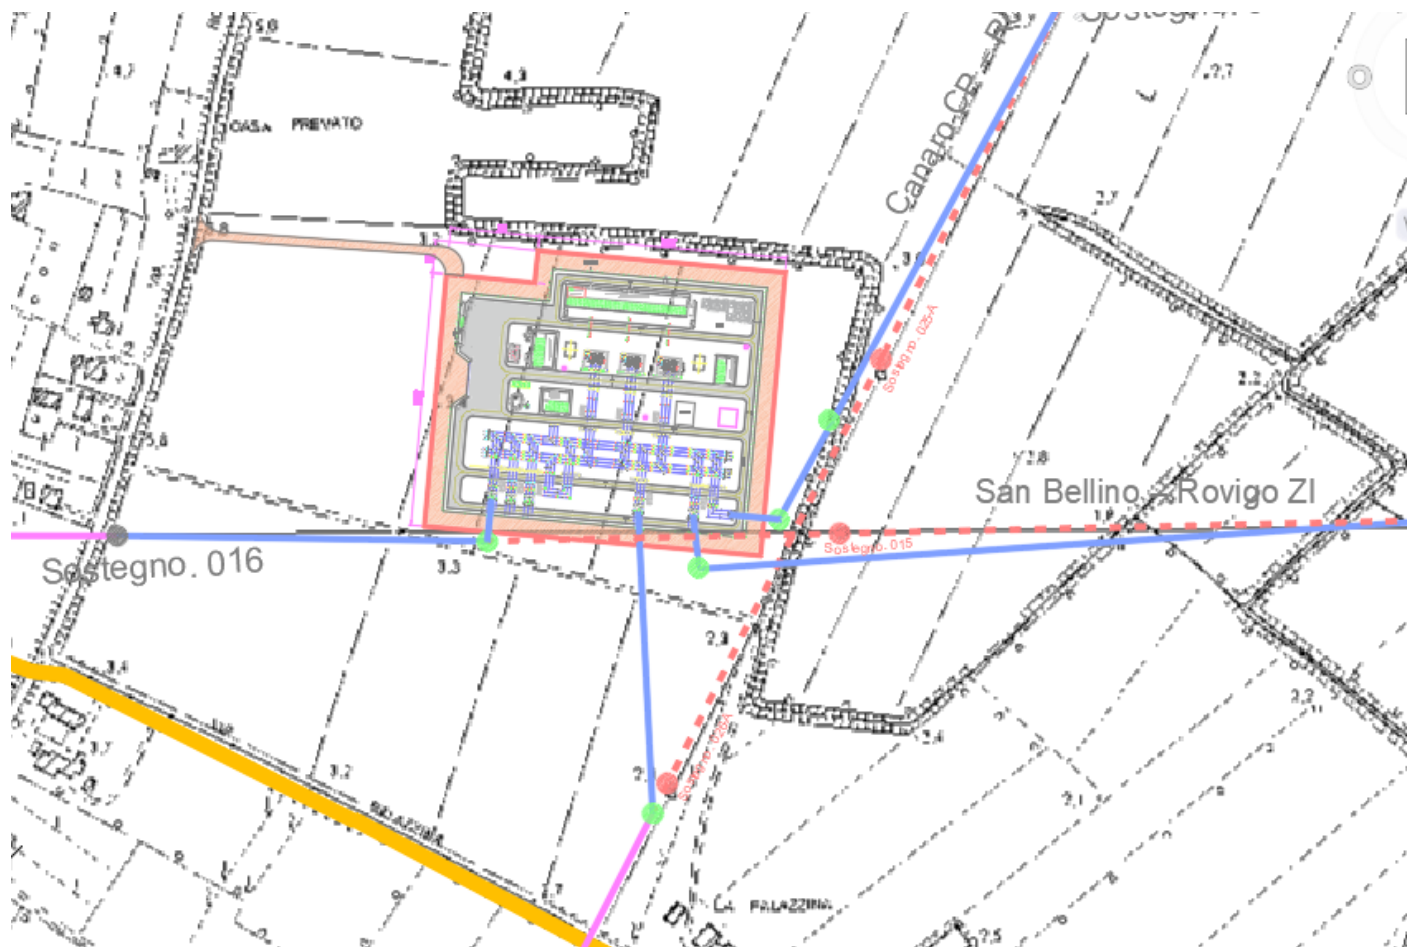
Planimetria elettromeccanica stato di progetto su CTR
